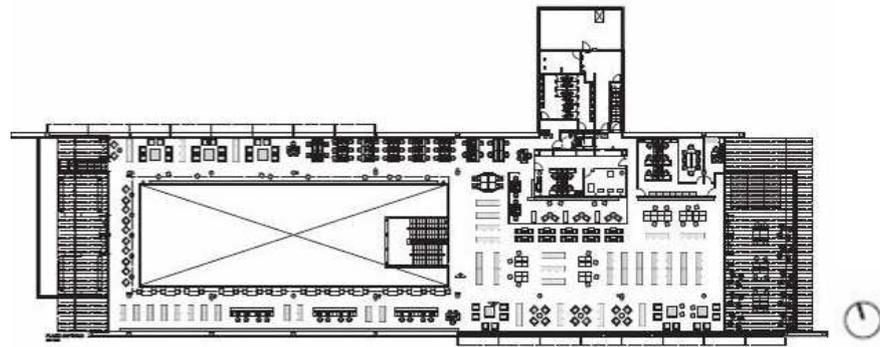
Planta baixa primeiro pavimento (DUCCI, LARSEN, MARTINS, 2010)
